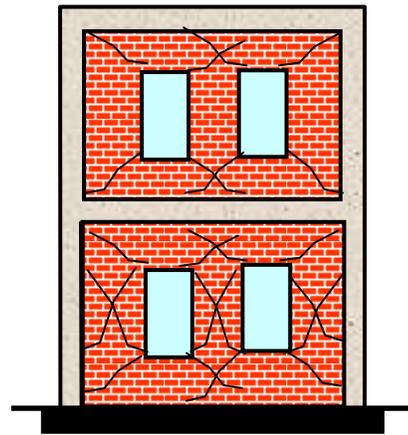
Clásicas grietas a 45° que se presenta en muros de mampostería como consecuencia de un sismo
